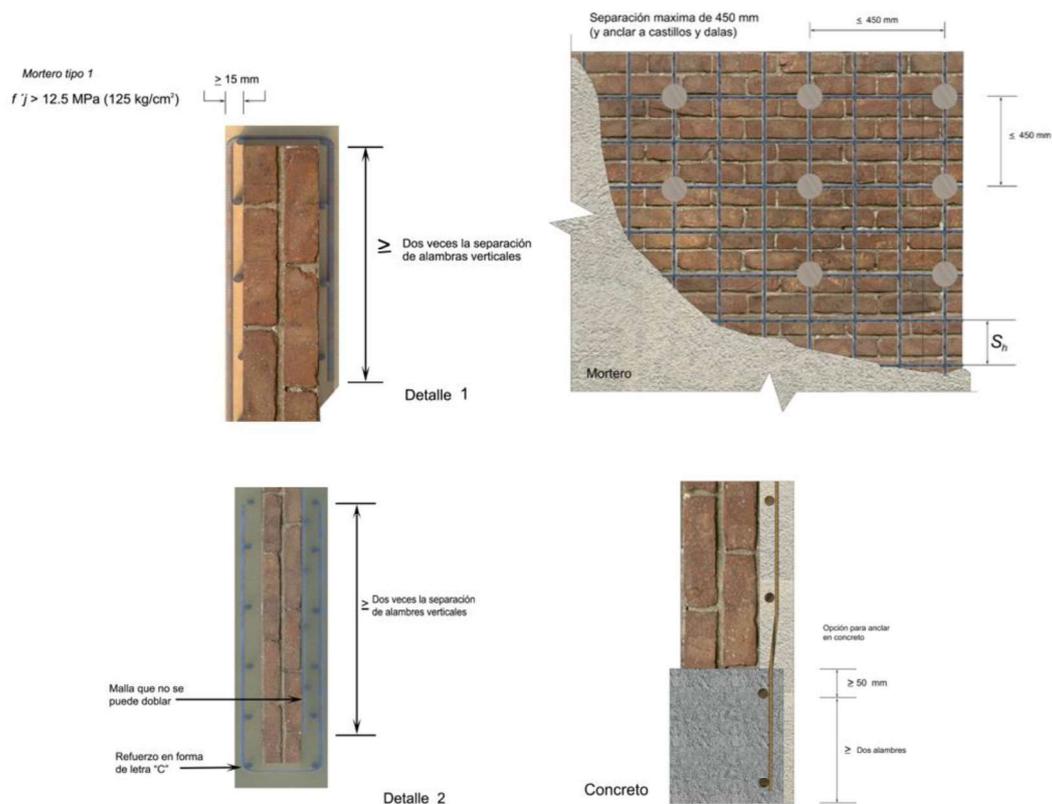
e – Detalles para la colocación de malla de alambre soldado sobre muros de mampostería
